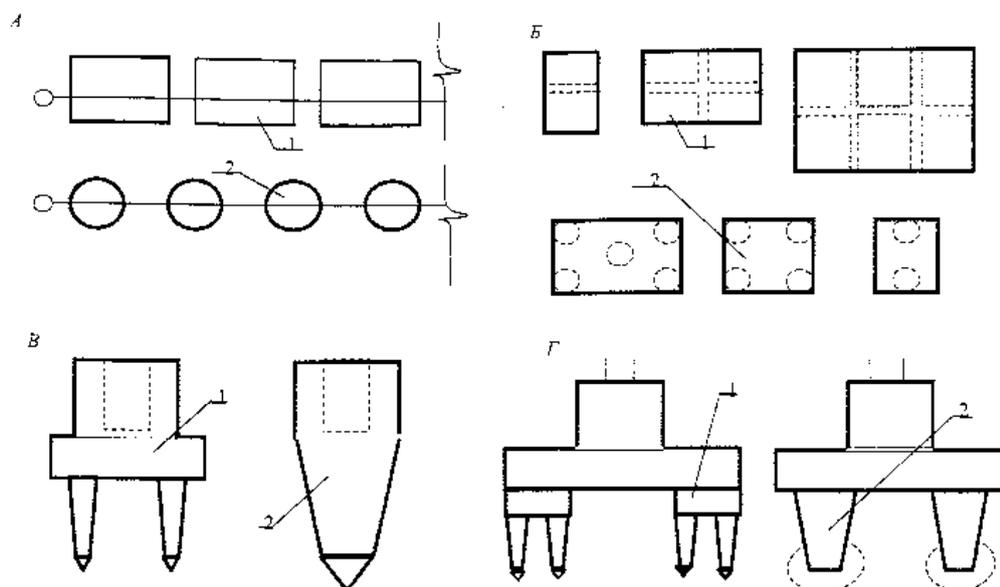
Типы фундаментов с выштампованным и вытрамбованным основанием:
